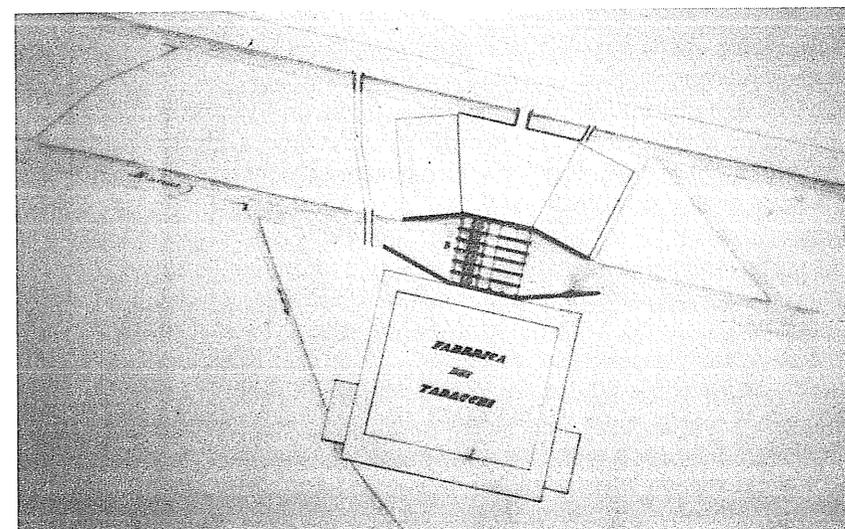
Pianta della fabbrica dei tabacchi di Chiaravalle, metà Ottocento. Archivio di Stato di Roma, Collezione disegni e piante, I.
